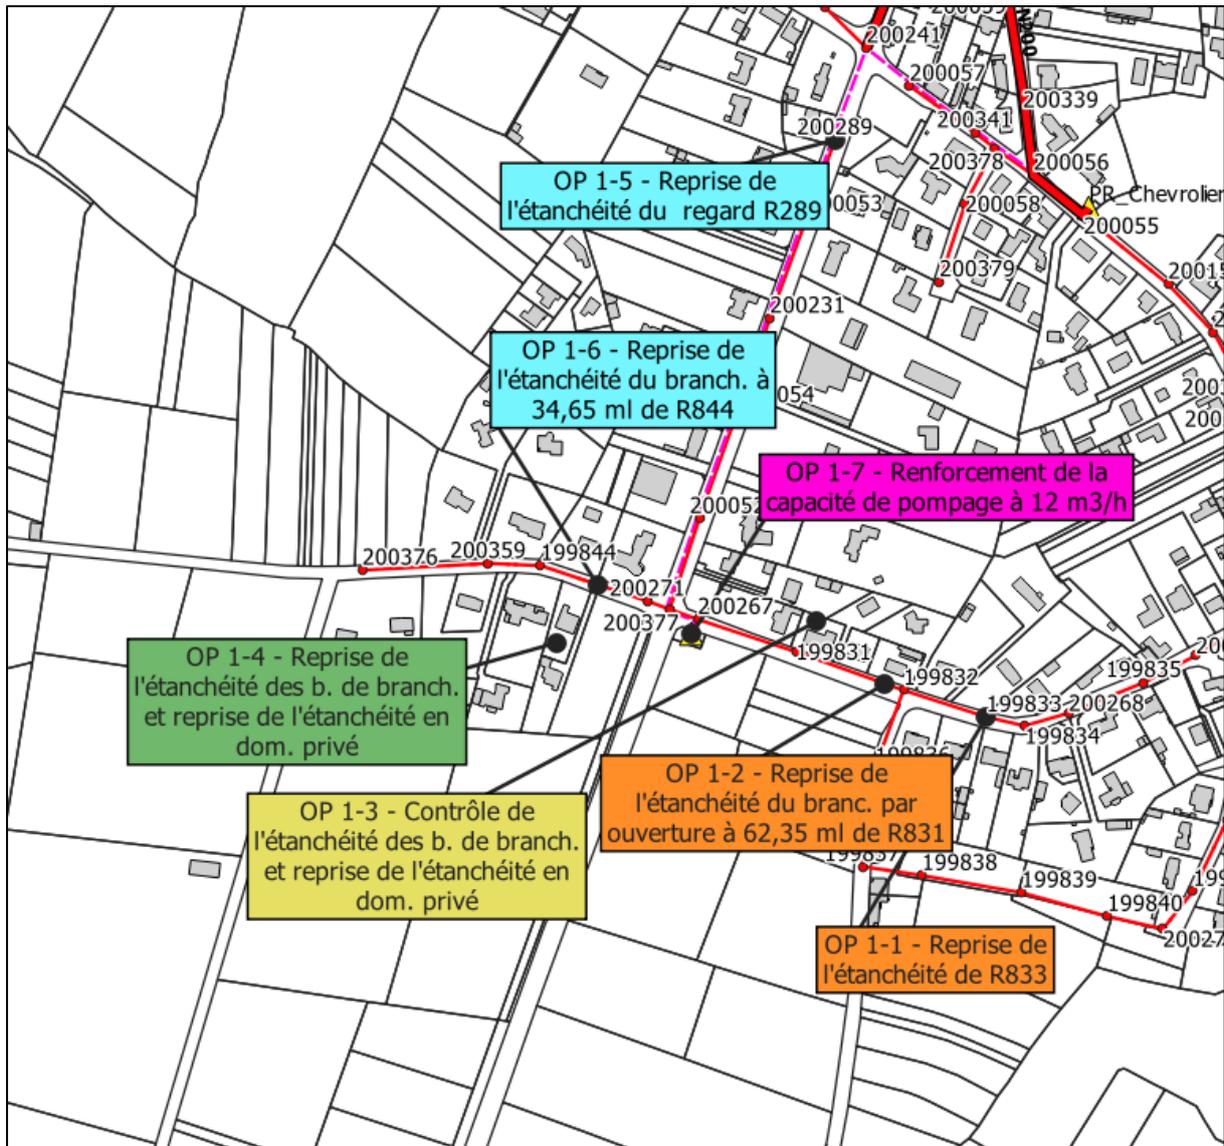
Plan des travaux préconisés - Secteur beauséjour
